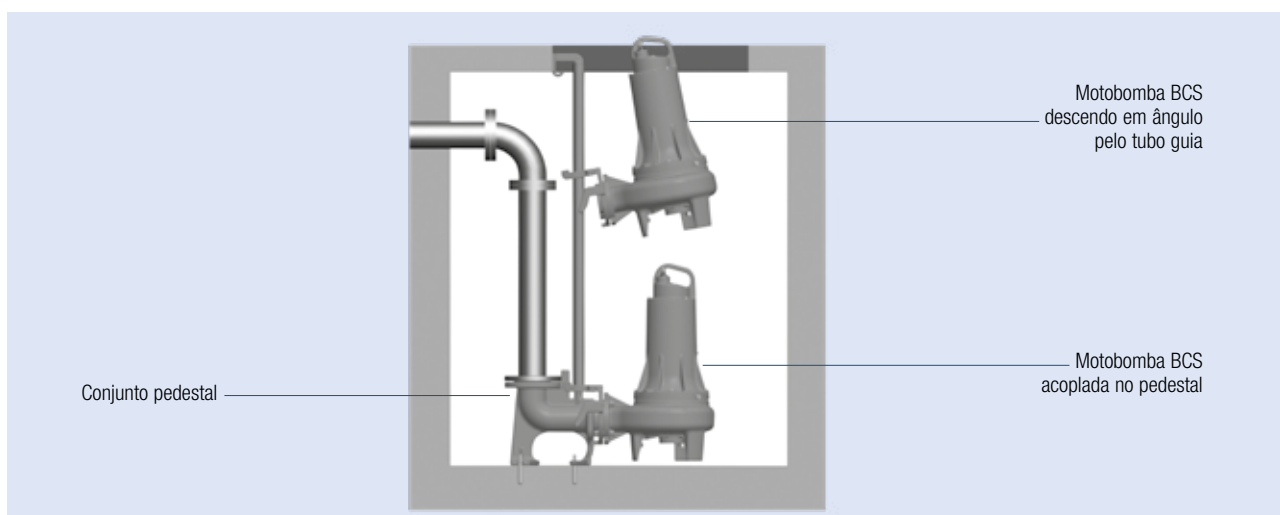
Instalação da motobomba com sistema de acoplamento direto no pedestal.
